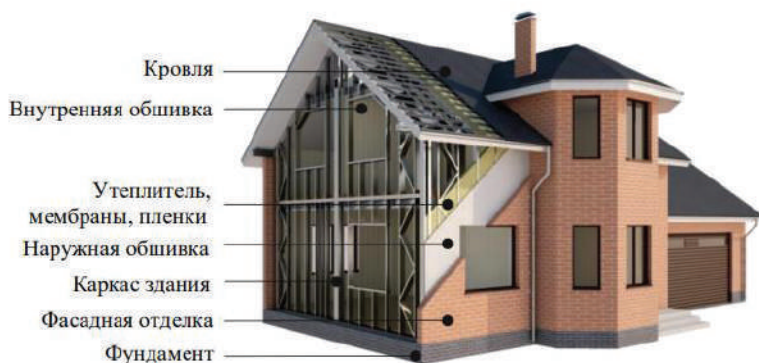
Схематичное изображение каркаса здания на основе ЛСТК с обшивкой и утеплением
